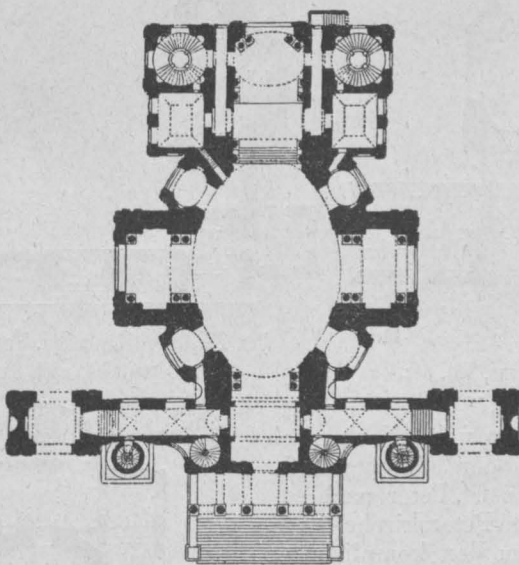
Grundriß der Karlskirche, IV. Bez.
